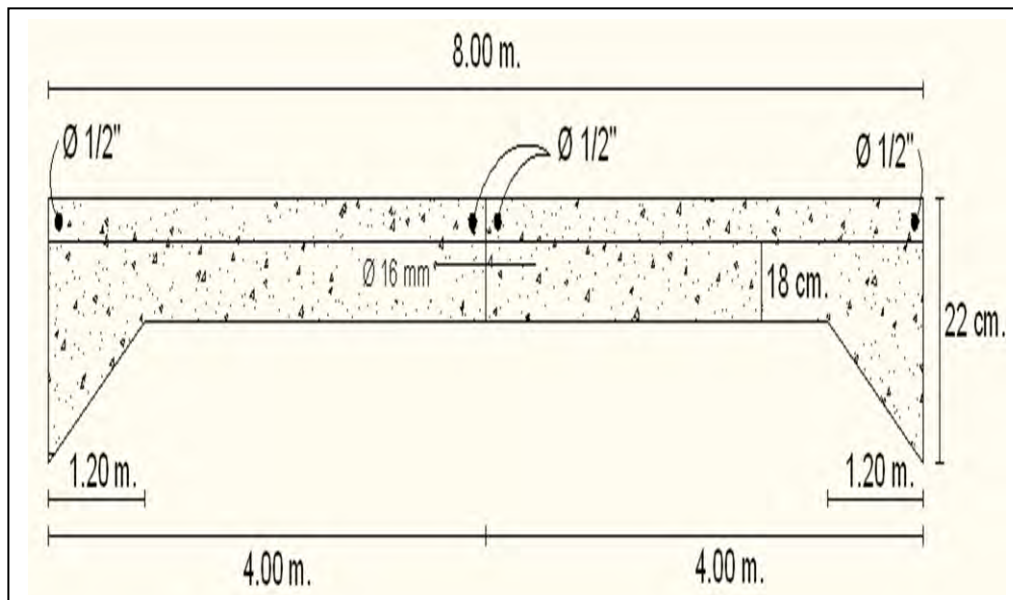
Sección del pavimento en avenida El Progreso (1924)
